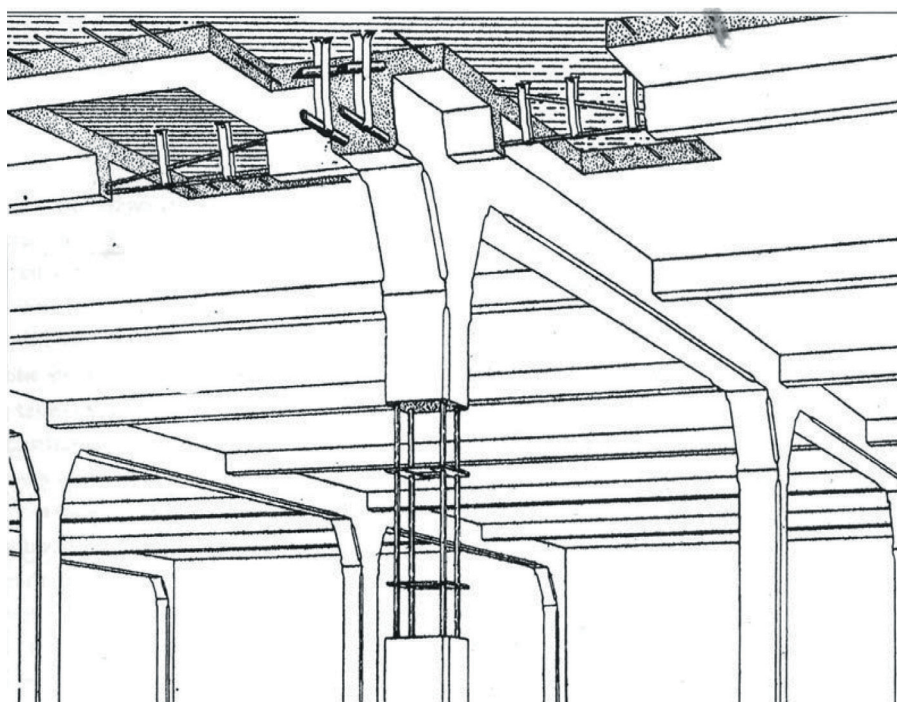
Esquemas estructurales del sistema Hennebique patentado en el año 1898.
